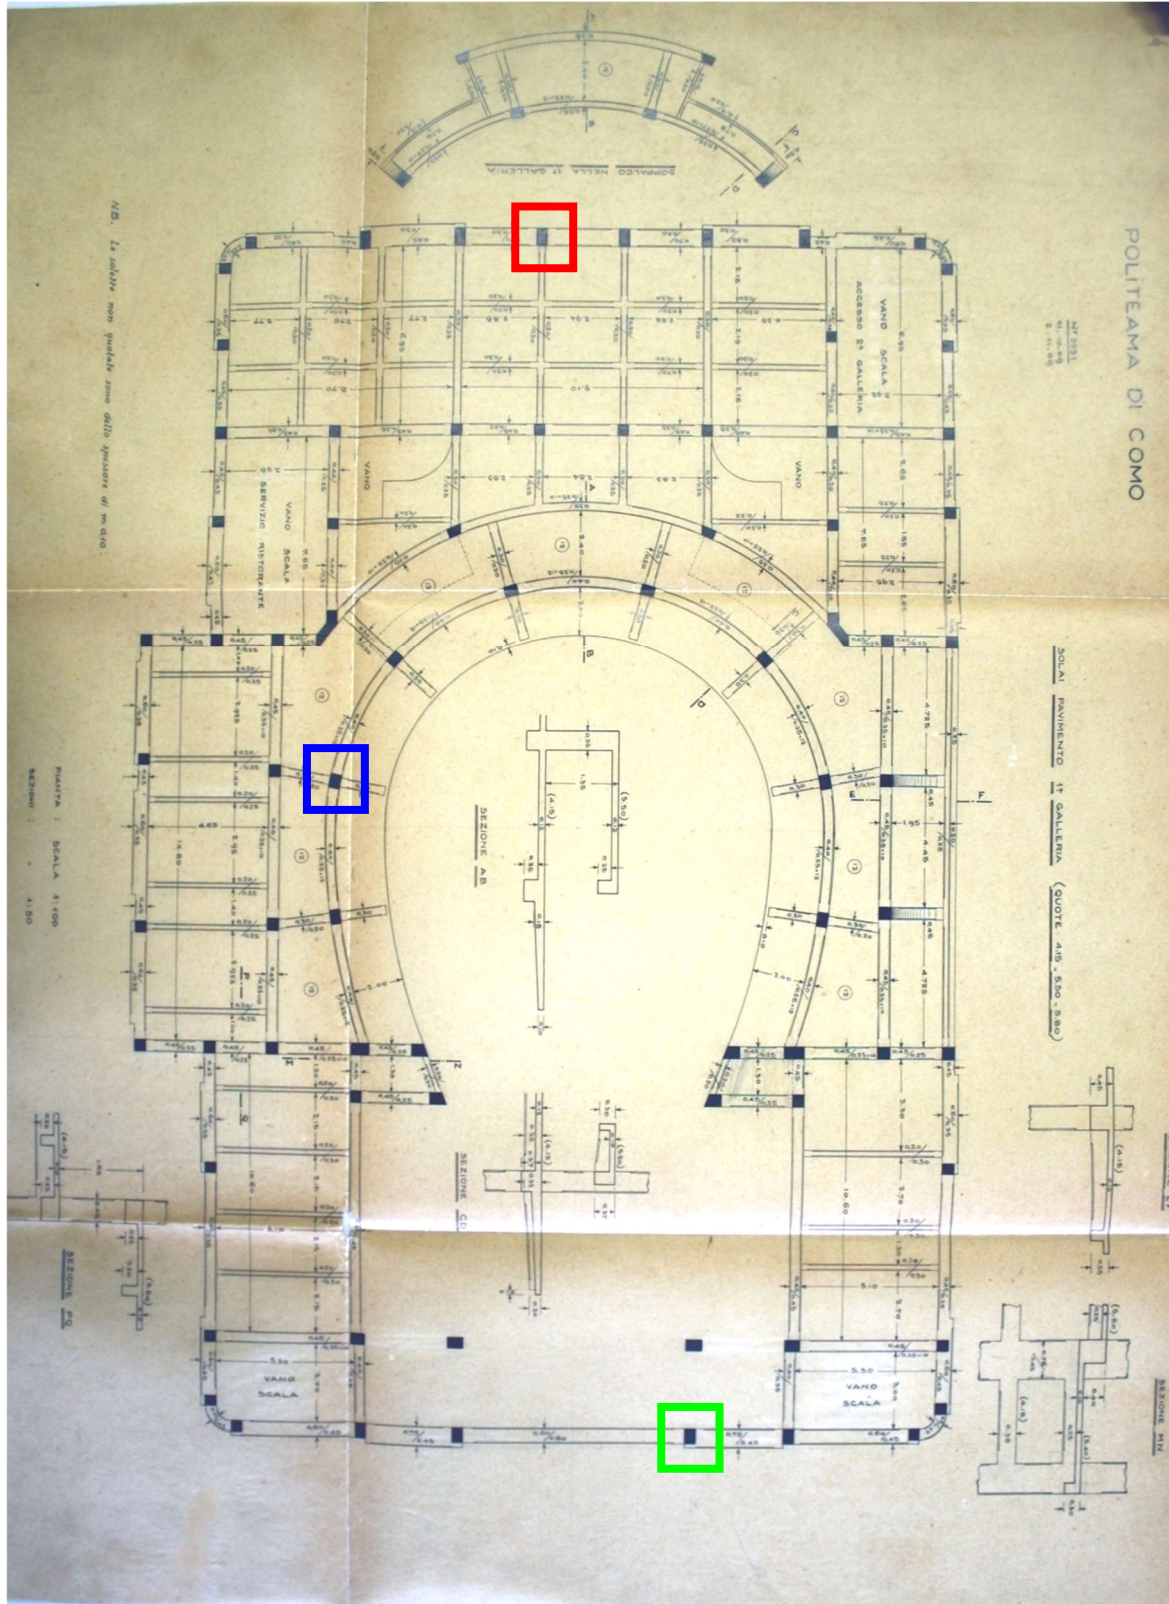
Posizione in pianta Pilastro 1(rosso), Pilastro 2(verde), Pilastro 3(blu)
